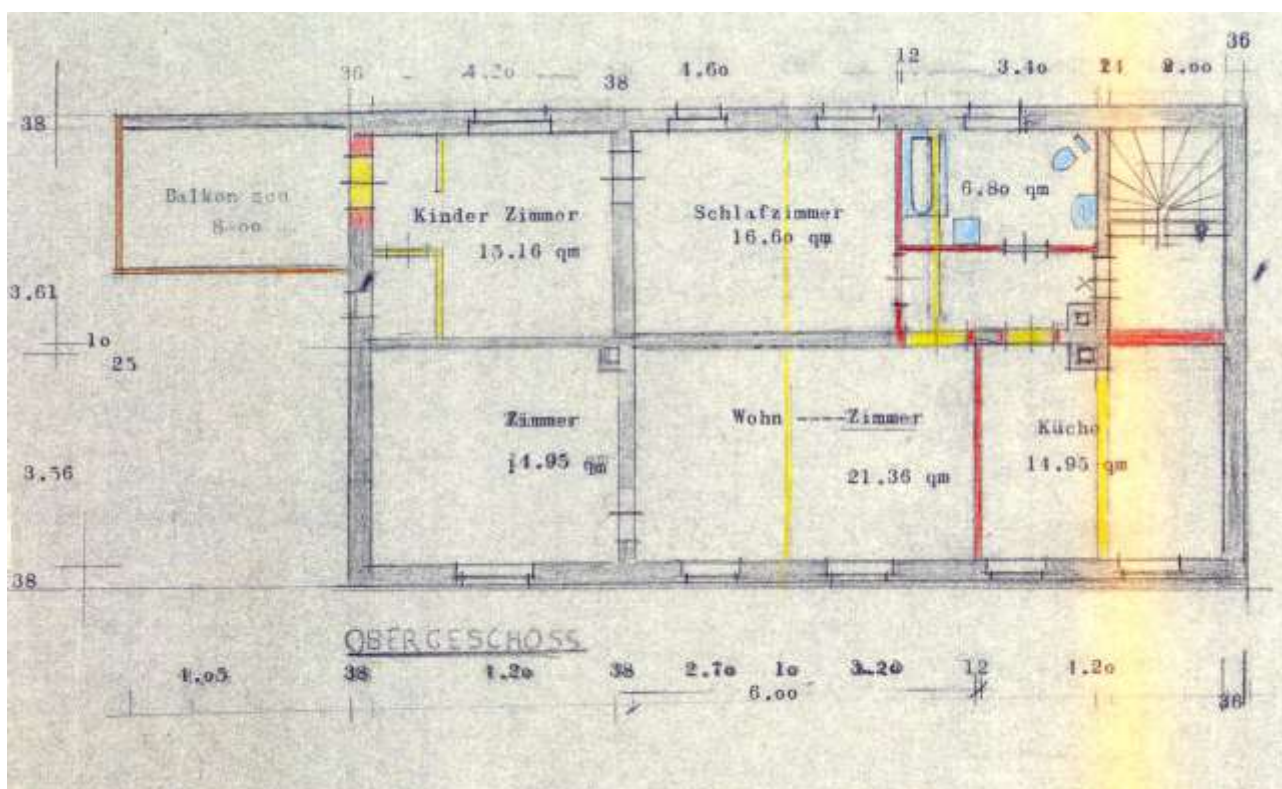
Mauerwerksrisse im verbliebenen Mauerwerk
